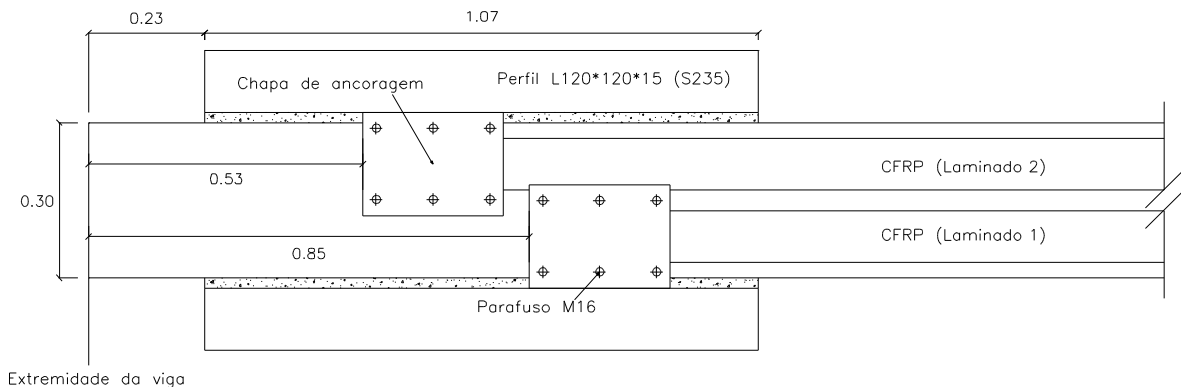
Vista inferior da zona de ancoragem dos laminados de CFRP (dimensões em m).
